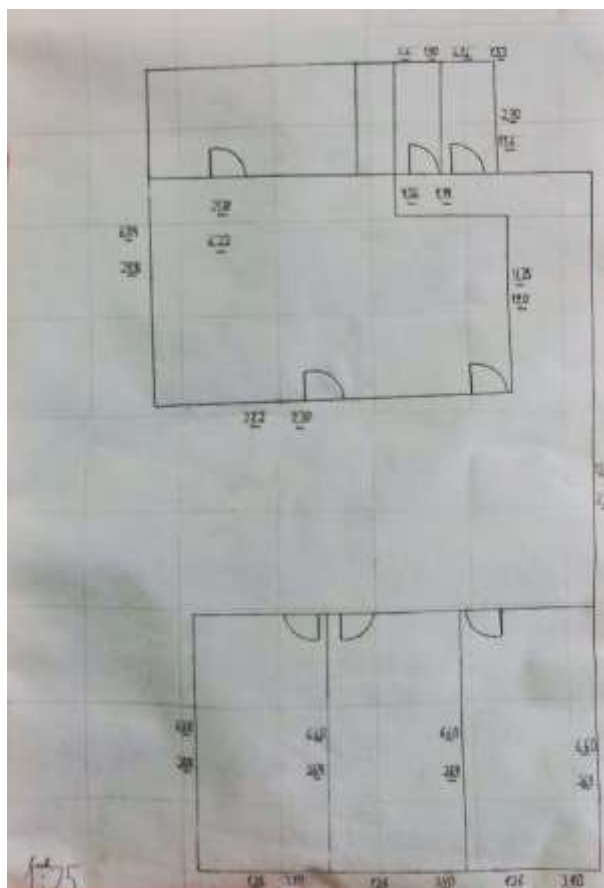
Resultado final da planta baixa. Fonte: acervo do autor, 2018.
